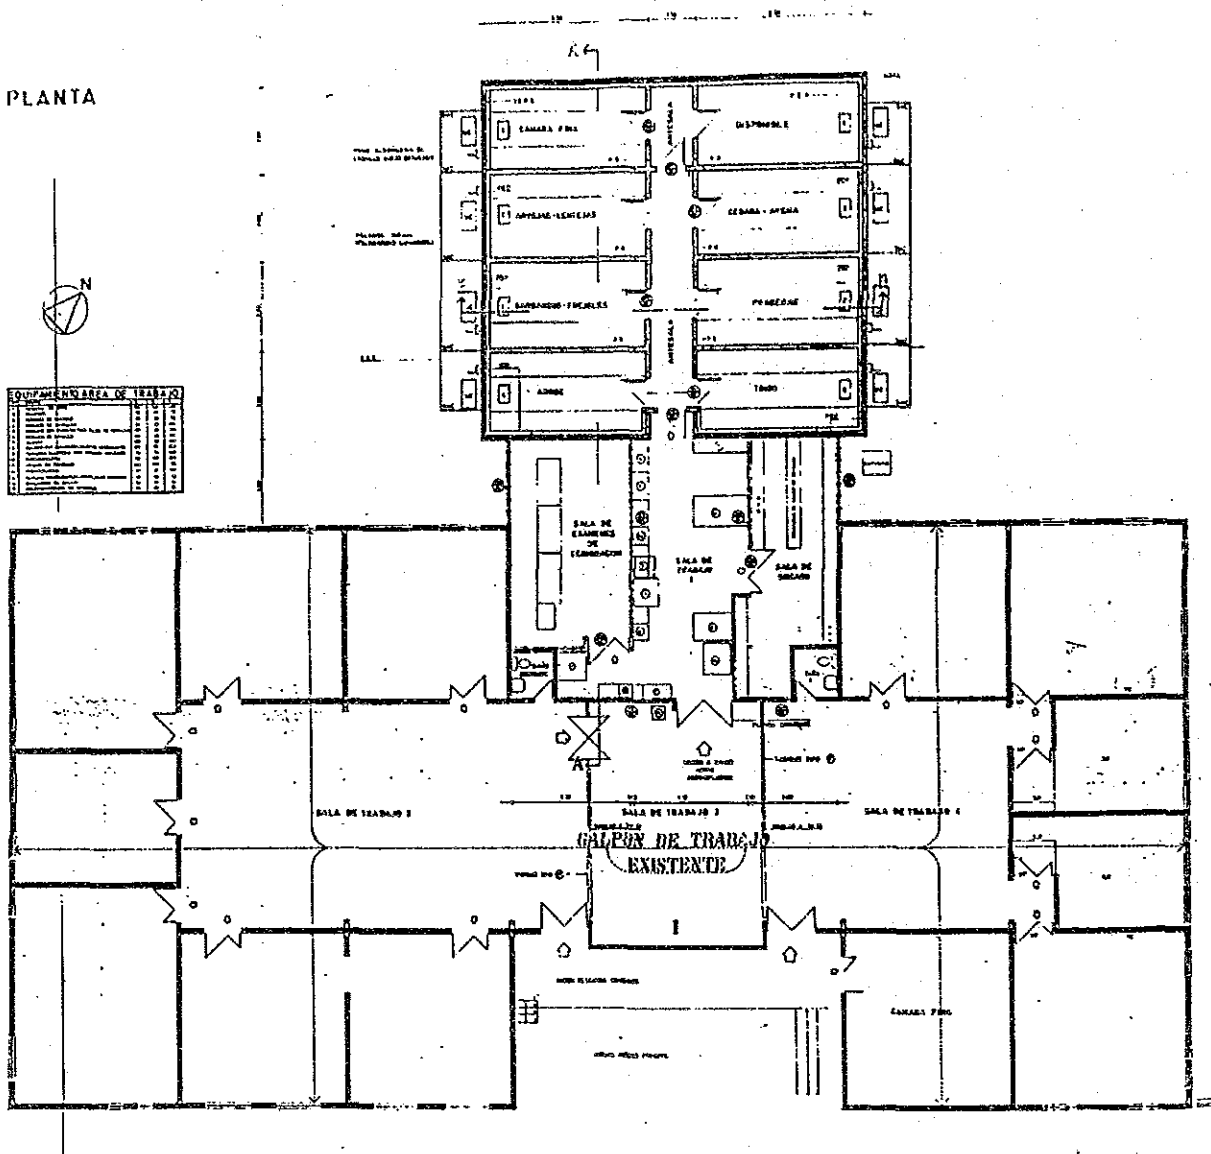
Quilamapu の Active Bankの貯蔵庫の平面図
